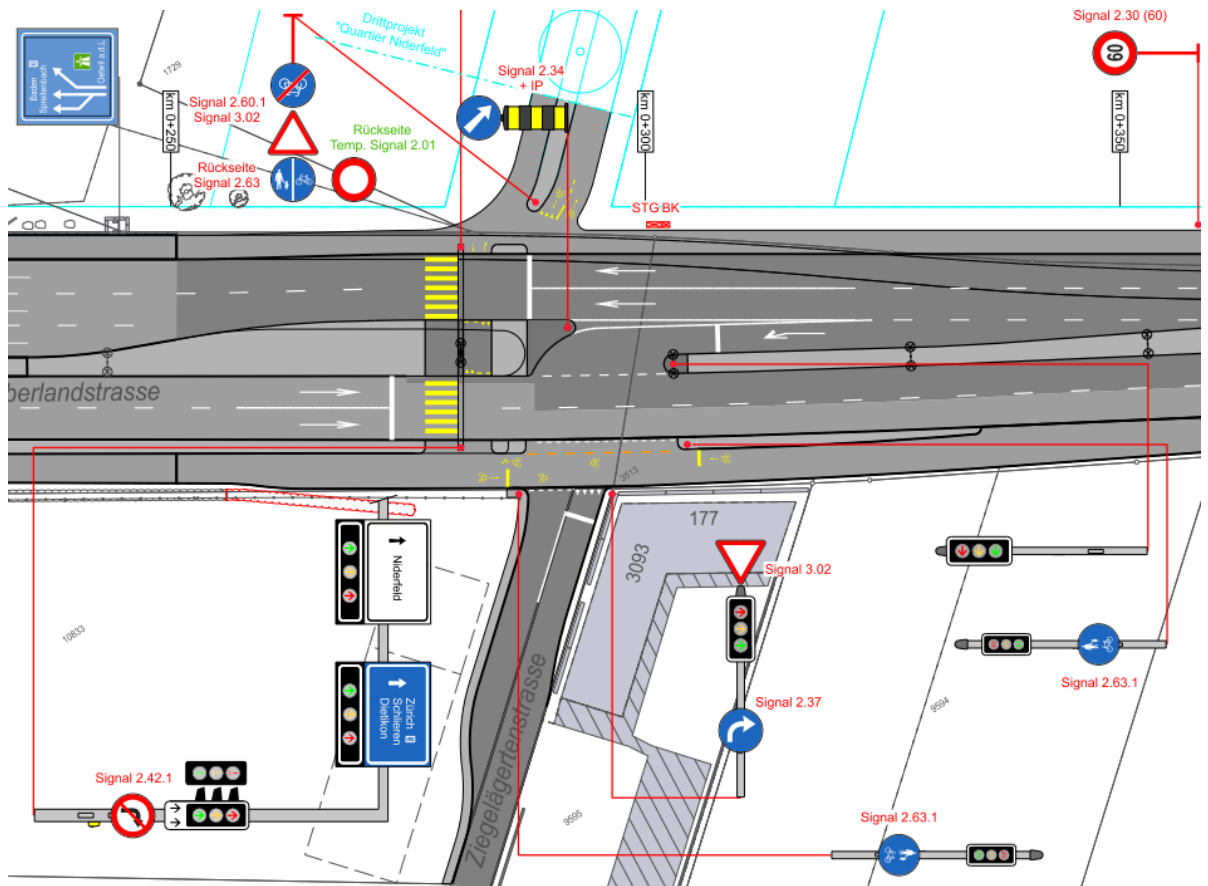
Veloführung im Bereich der Querungsstelle und Zufahrt Ziegelägertenstrasse
